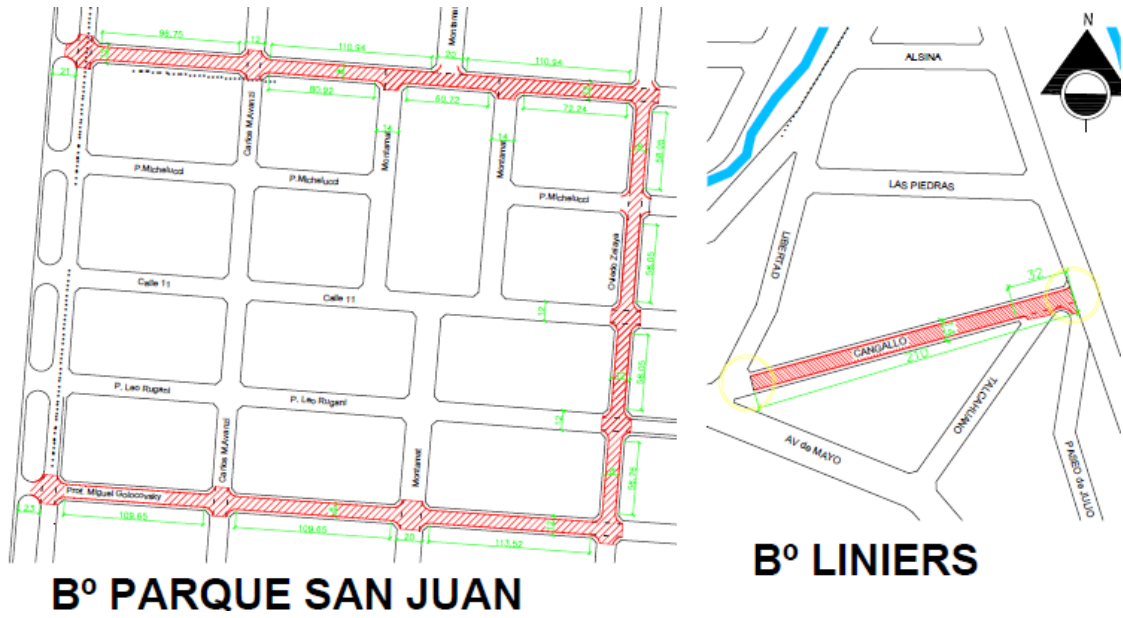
Calles a pavimentar en barrios Parque San Juan y Liniers.
